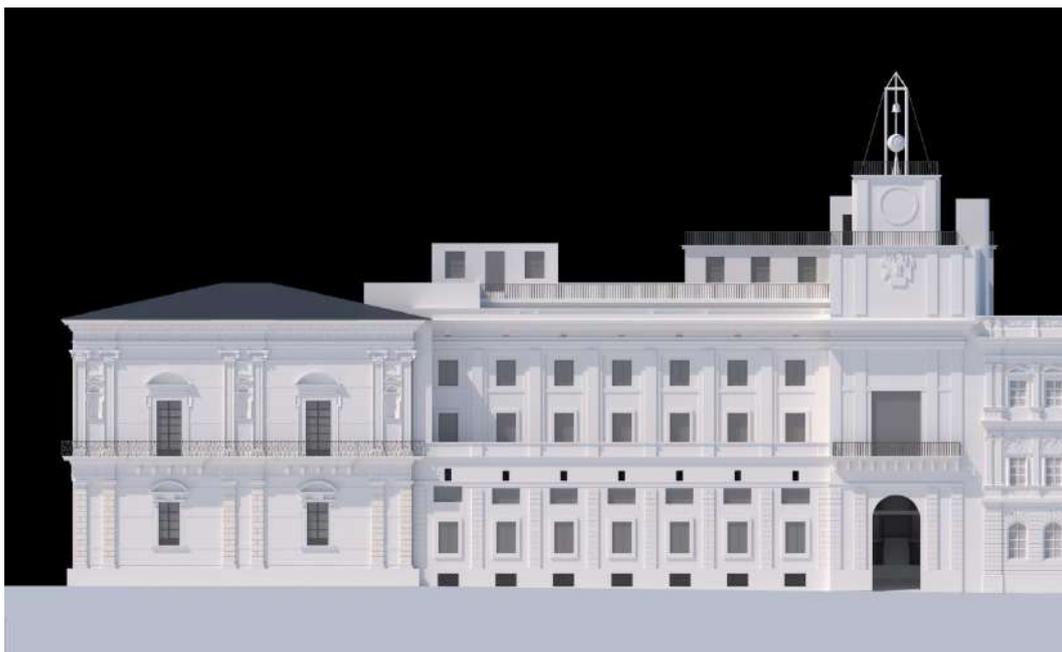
Prospetto su Via Minerva, progetto di Gaetano Rapisardi, 1964.
